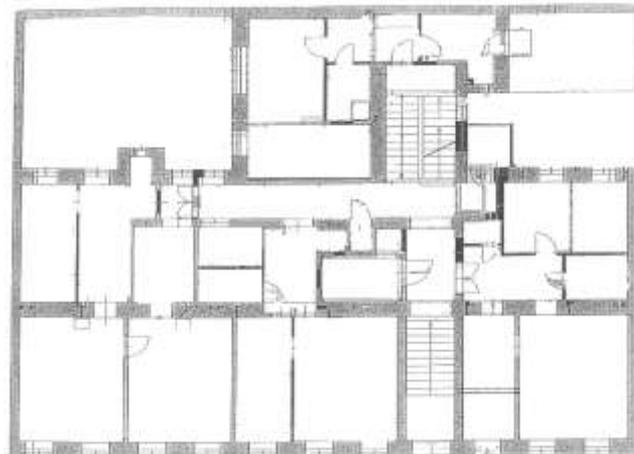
Grundriss Ortliebgasse 44
